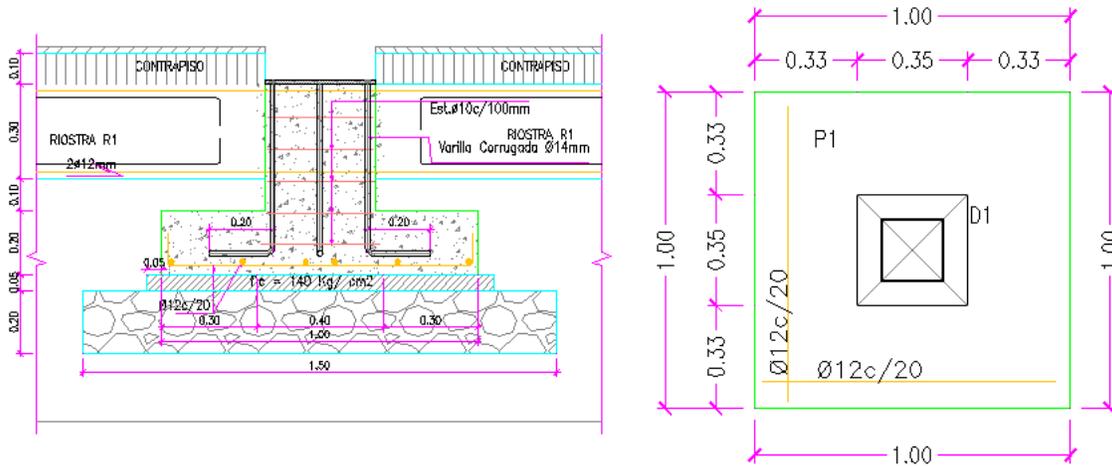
; Detalle de plinto 1 X 1 m para diseño de estructura metálica
